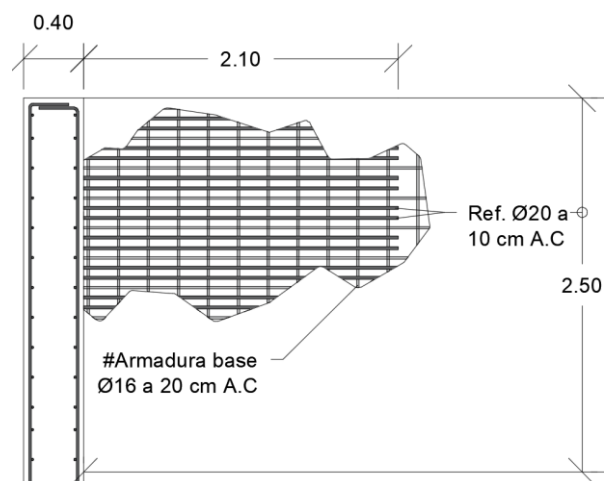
Refuerzo sobre armadura base en Muro Interno 3 (armadura horizontal)
